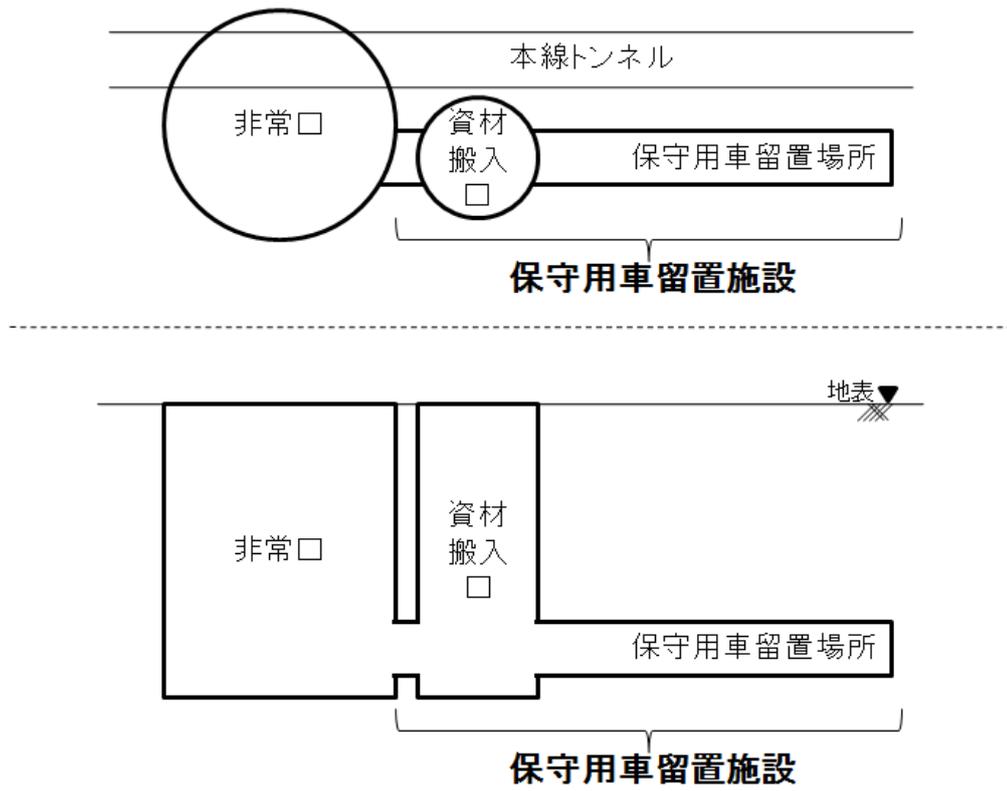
保守用車留置施設の概要（上段が平面図、下段が側面図）
